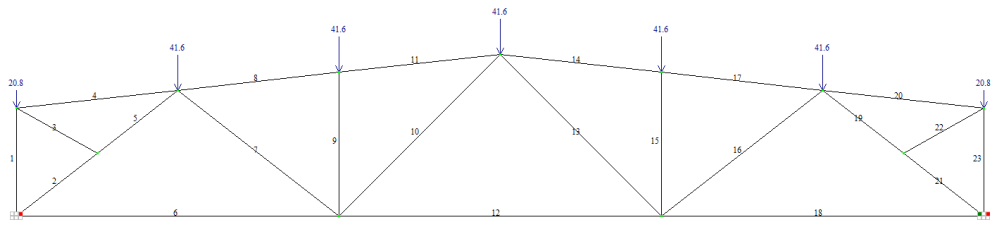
Схема загрузки кратковременной снеговой нагрузкой
